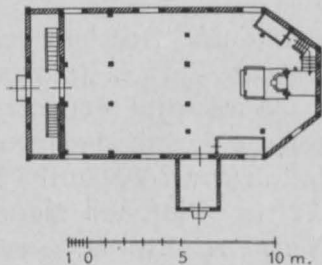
Groß-Lubolz. Grundriß der Kirche.
